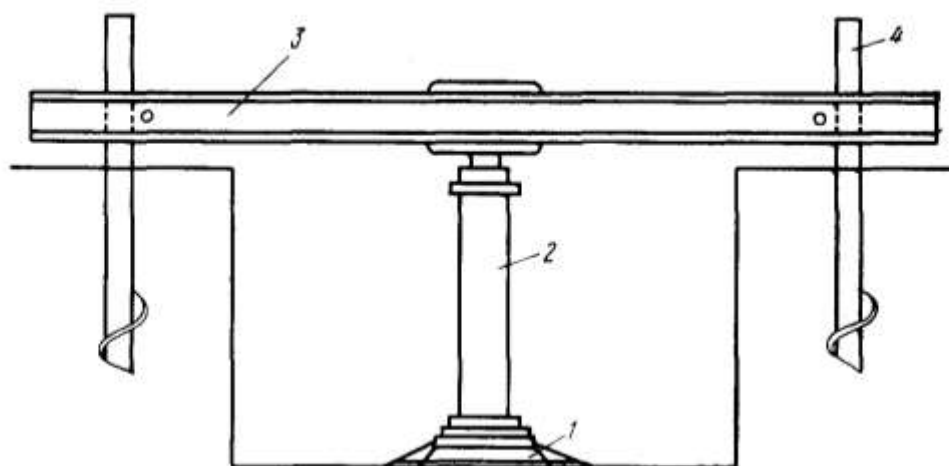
Схема установки для испытания грунтов пробной нагрузкой в шурфах. 1 — штамп; 2 — домкрат; 3 — упорная балка; 4 — винтовые анкеры
